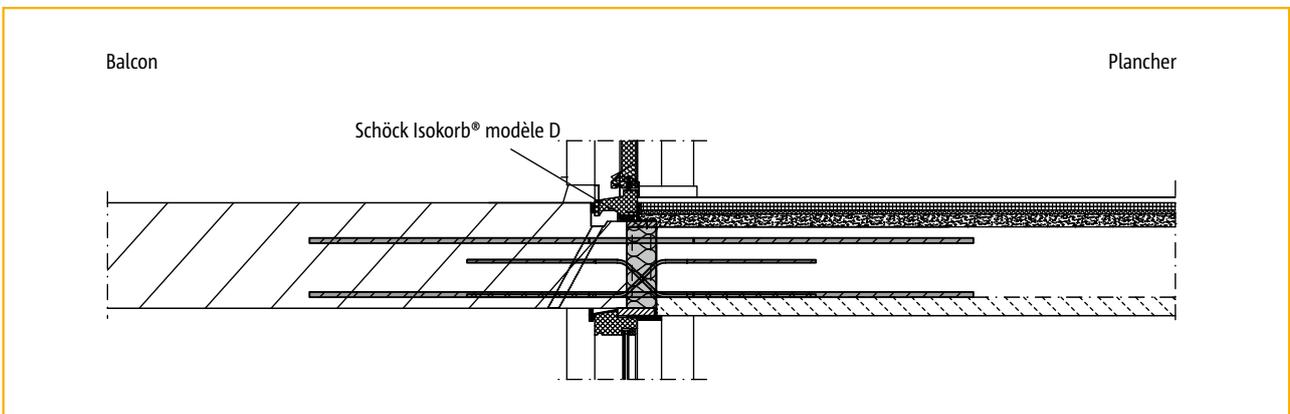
Liaison rupteur Schöck Isokorb® modèle D : balcon préfabriqué et prédalle
